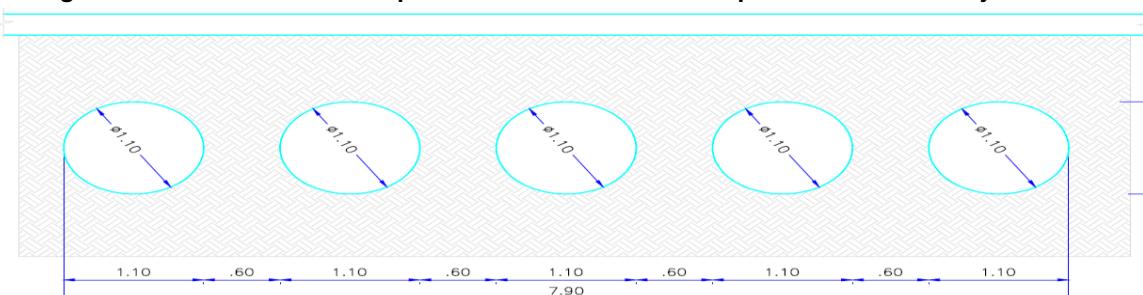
Planos de diseño tubería metálica corrugada para la obra de drenaje PR84+900
